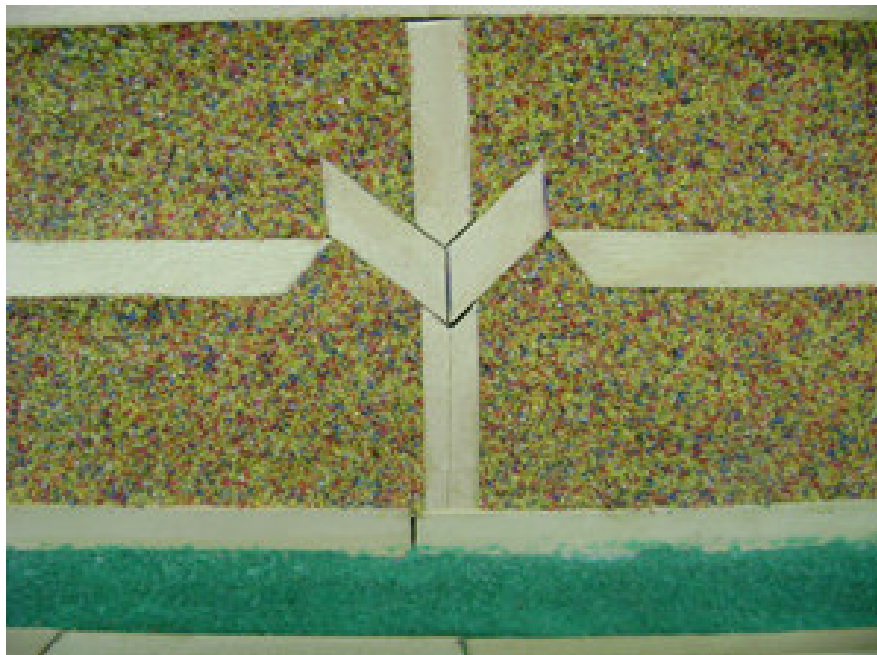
DETALHAMENTO 3 DO TELHADO E PAREDE LATERAL
